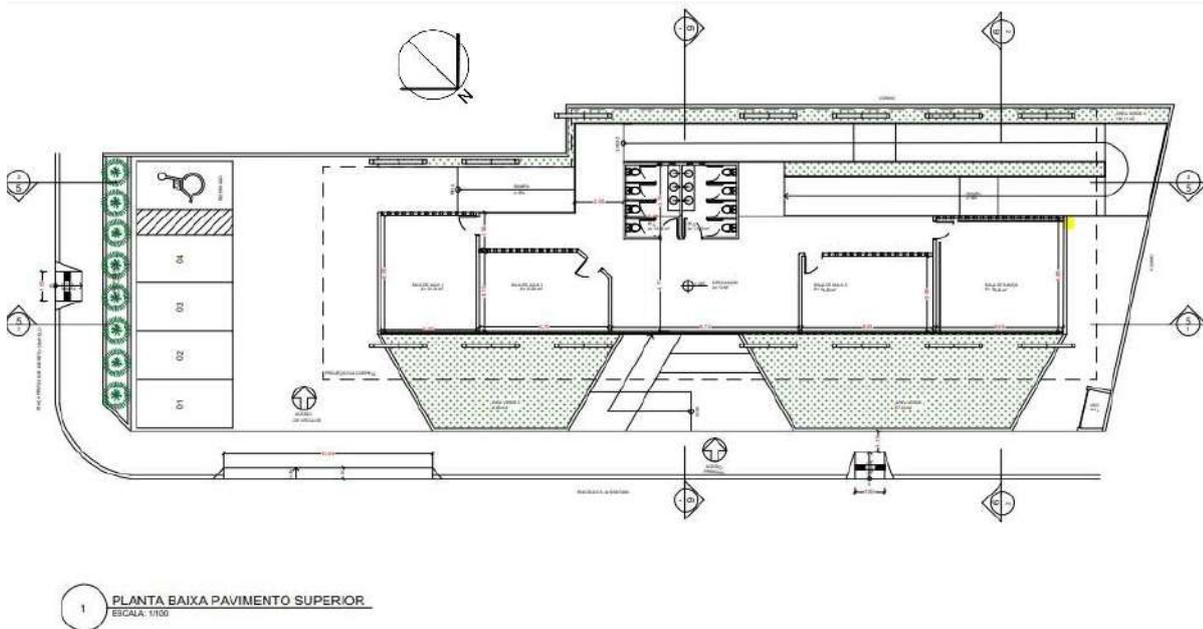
Centro de Educação e Cultura da Torre - Planta baixa – Pavimento superior
